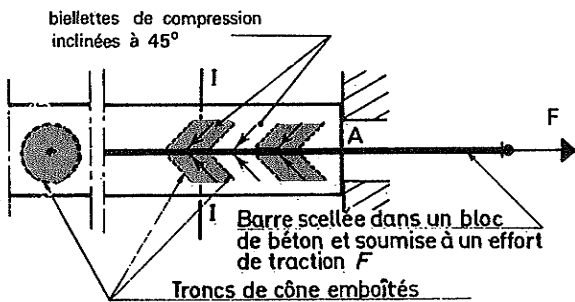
Mécanisme de l'adhérence béton-acier.
